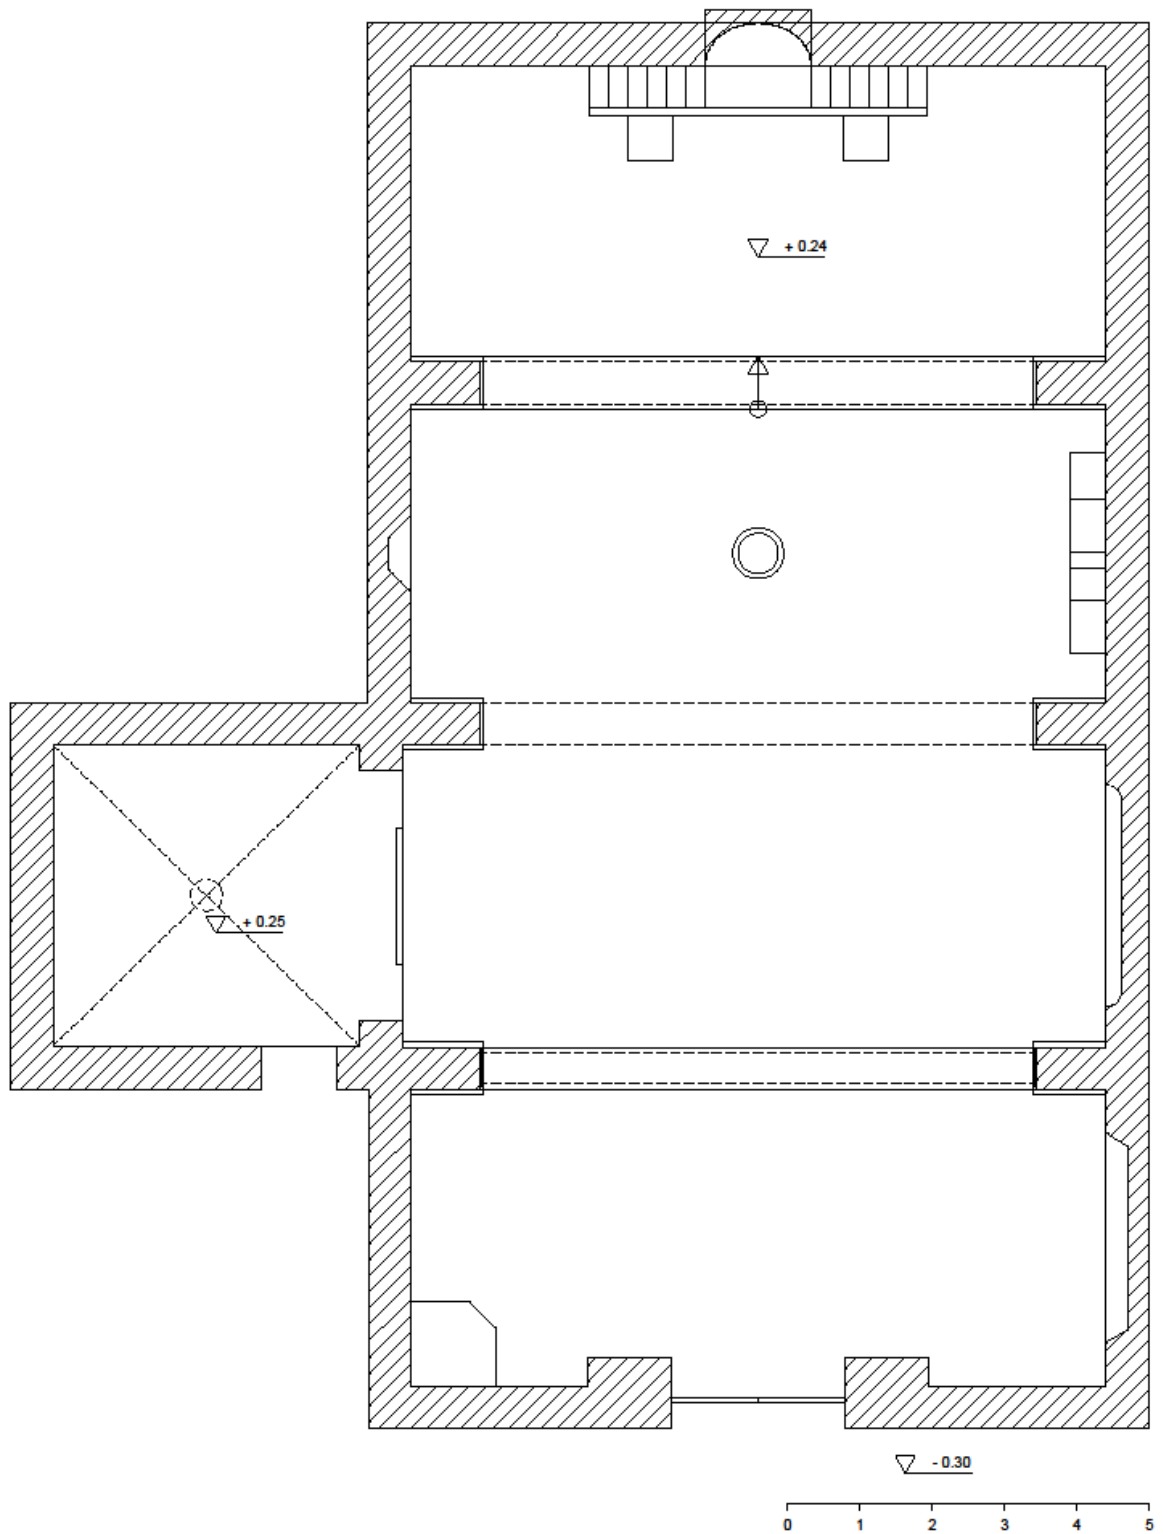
Planta iglesia de Santa Fe con sacristía.
